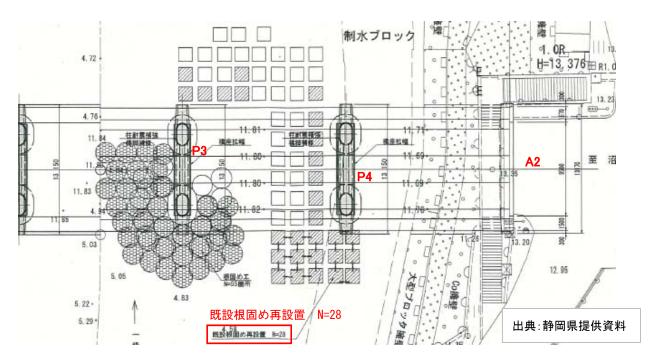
平成 25 年度 黄瀬川大橋橋脚補強工 平面図
